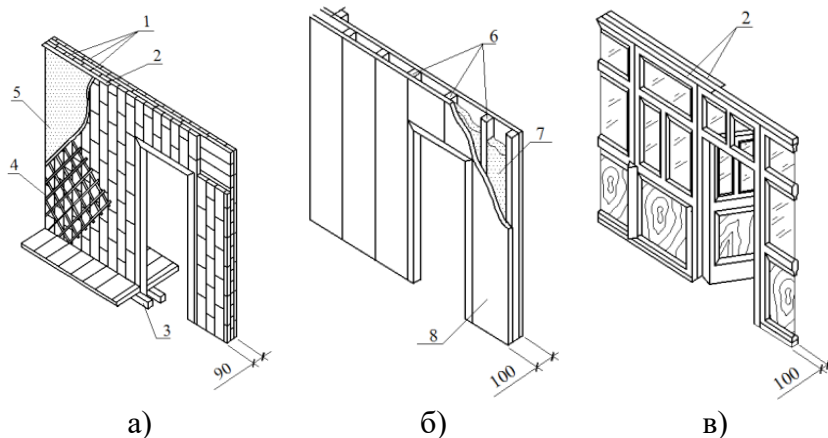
Дерев'яні перегородки: а – щитові; б – каркасні; в – столярні; 1 – тришарові дощаті щити; 2 – верхній ощеп; 3 – нижній ощеп; 4 – дранка; 5 – штукатурка; 6 – стійки каркаса; 7 – засипка; 8 – обшивка
